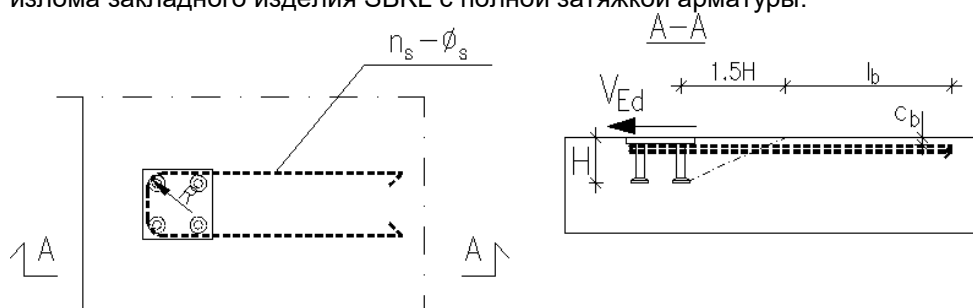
Дополнительное армирование закладного изделия SBKL на поперечную силу и крутящий момент
